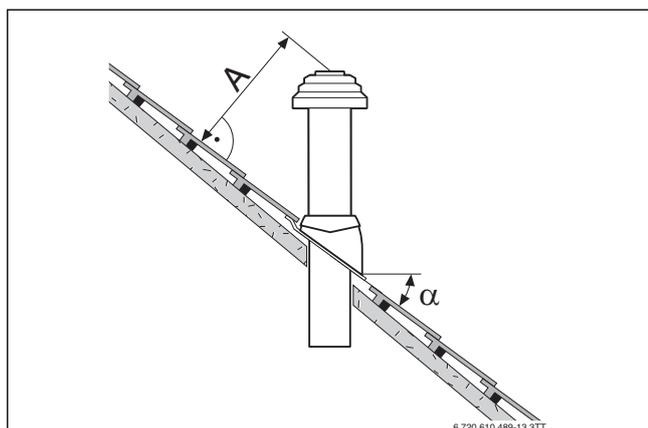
Abstandsmaße und Dachneigungen bei Schrägdach
